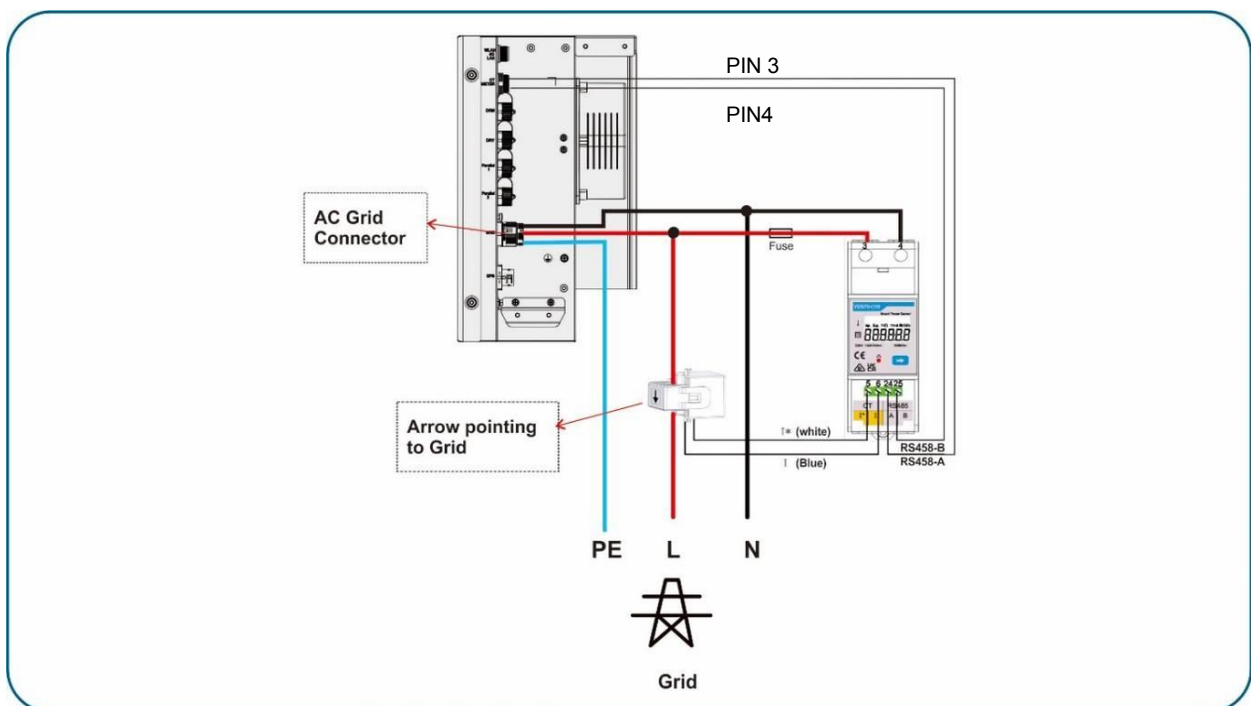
Cablaggio del collegamento dello smart meter (esempio, YaDa YDS70-C16)
